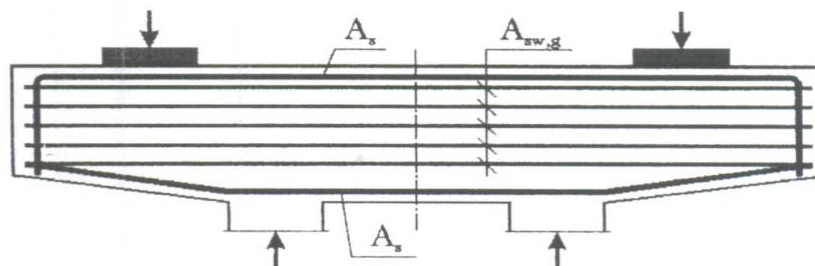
Армирование двухконсольных балок, разработанное институтом строительства во Франции
